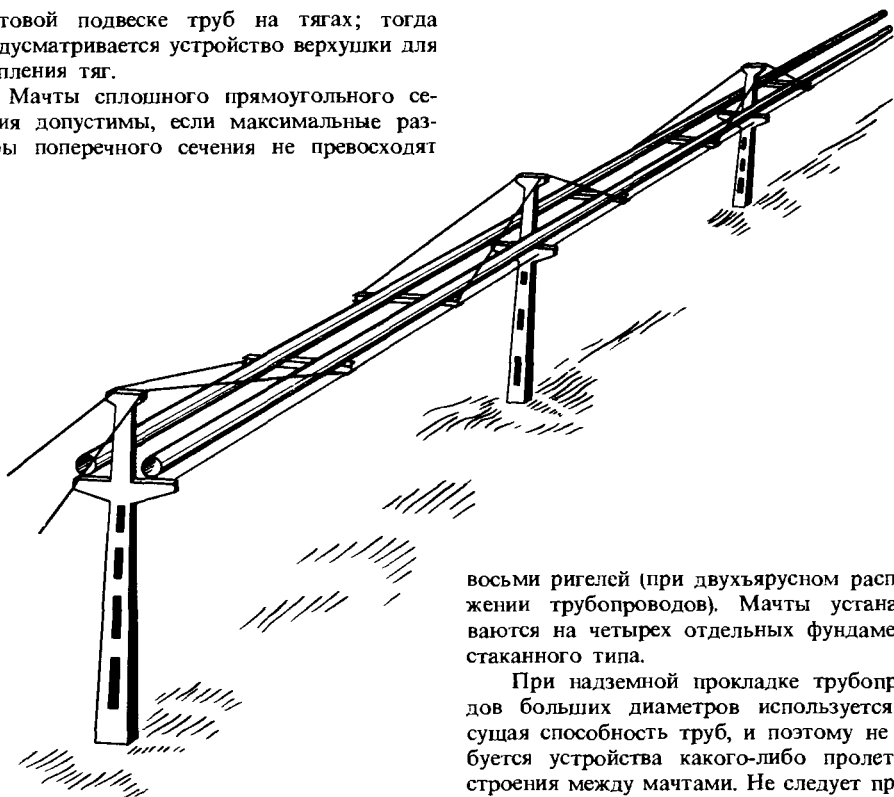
Прокладка труб с подвеской на тягах (вантовая конструкция)
